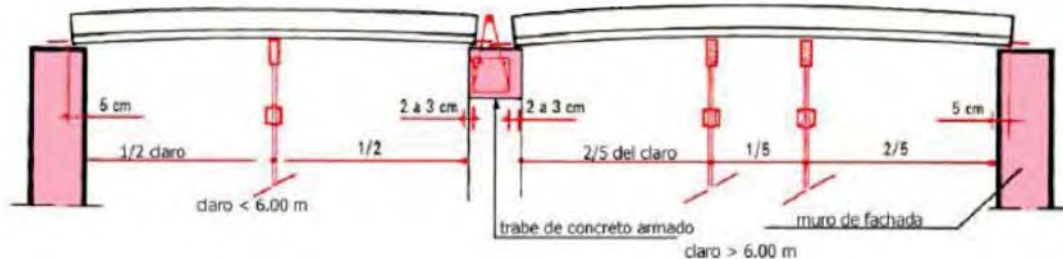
APUNTAMIENTO DE VIGUETAS PRESFORZADAS SEMIRESISTENTES (Y DE ALMA ABIERTA)
